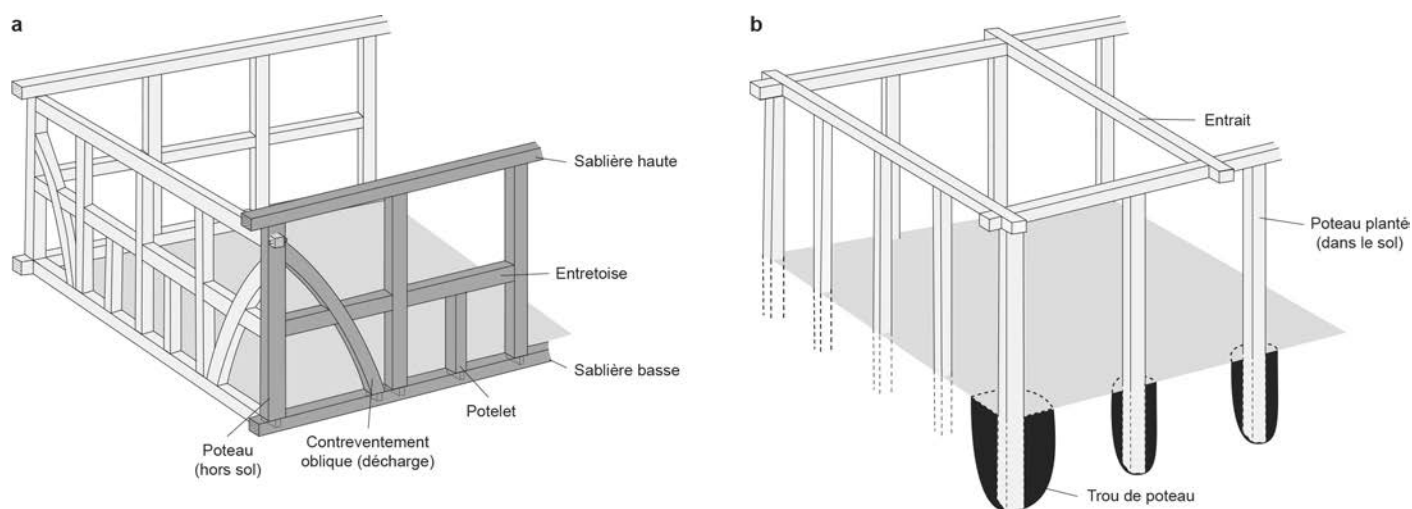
Exemple de constructions : a, une construction en pan de bois avec, en partie grisée, la matérialisation de ce dernier ; b, une construction sur poteaux plantés (DAO : P. Péfau, d'après Volmer, Zimmermann 2012, fig. 116).
